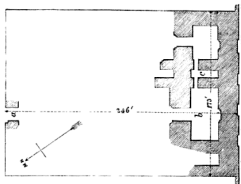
Grundriss der Wauwaarino von Warka.
